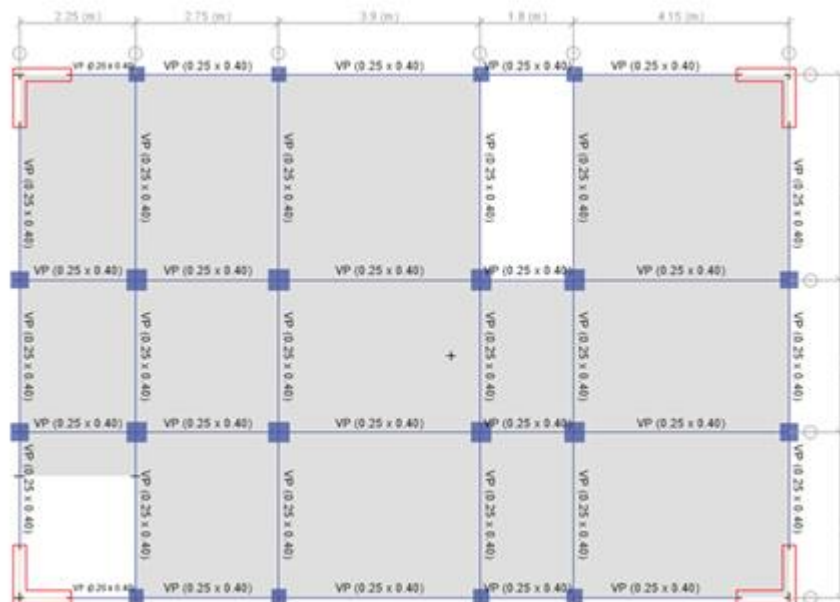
Plano de planta con las placas seleccionadas en rojo – ETABS
